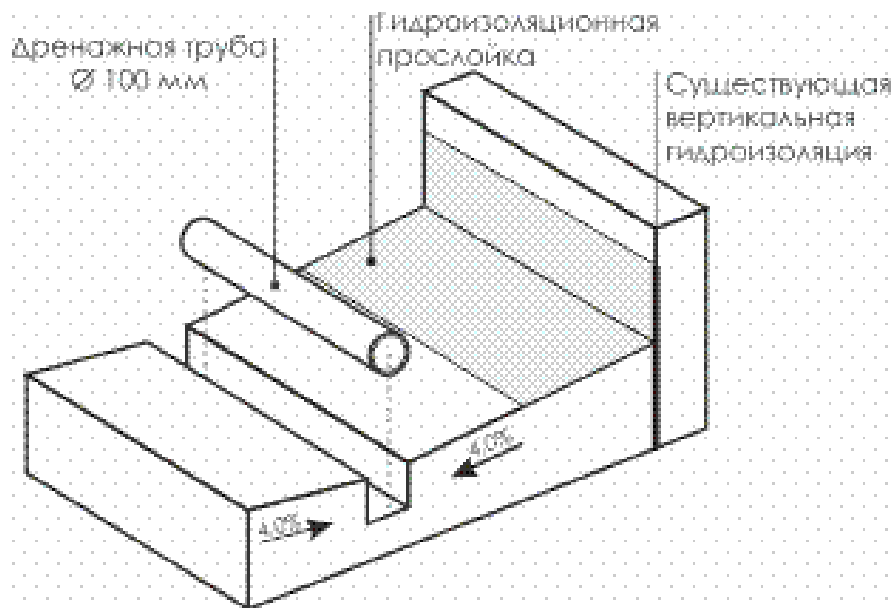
Устройство дренажа и вертикальной гидроизоляции
